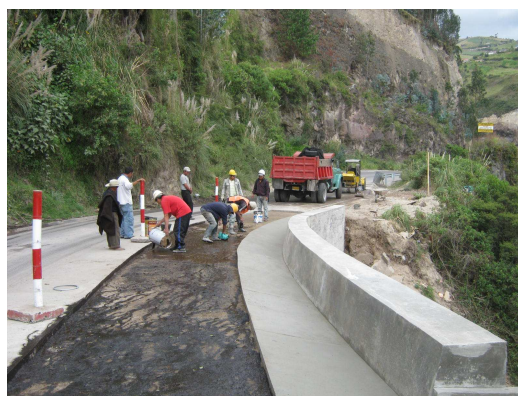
y 129 Construcción del vertedero en concreto reforzado
